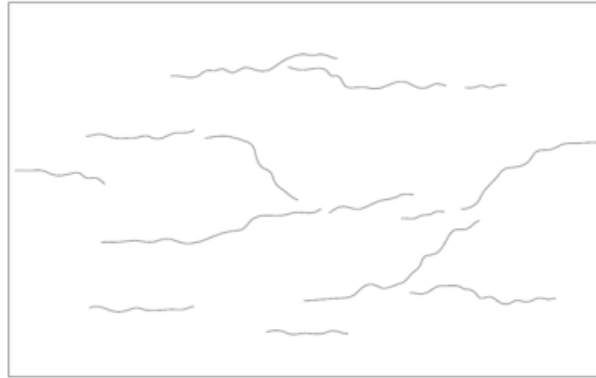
Fissuras típicas de retração plástica do concreto
